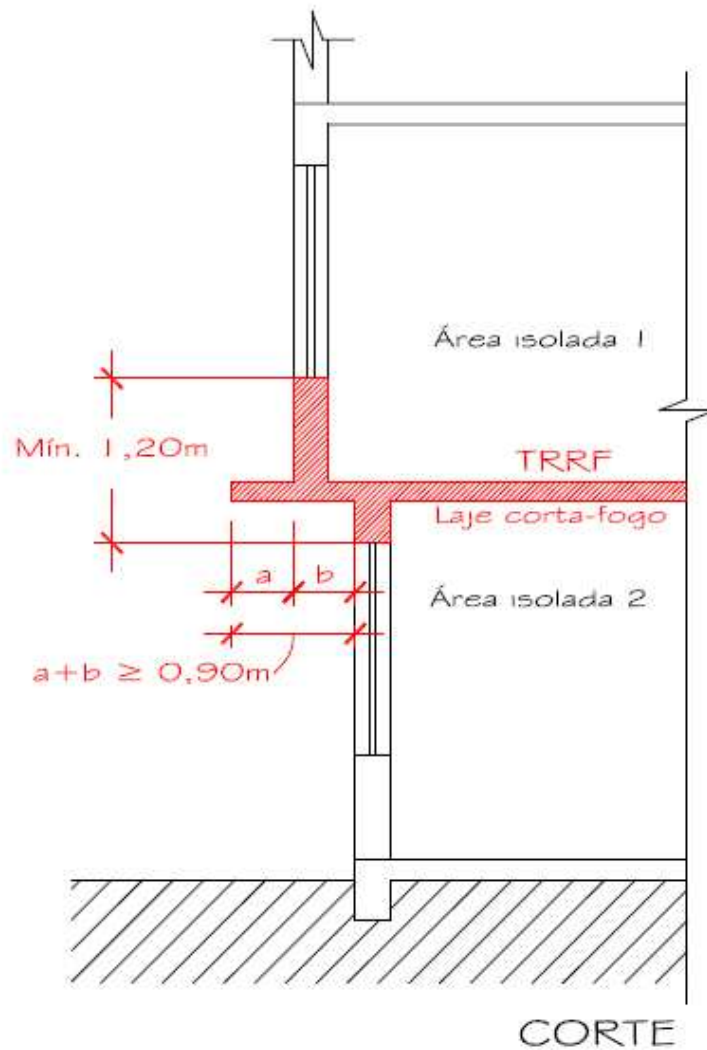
Distância vertical entre aberturas dotadas de aba ou marquises em conjunto com a projeção entre pavimentos isolados
